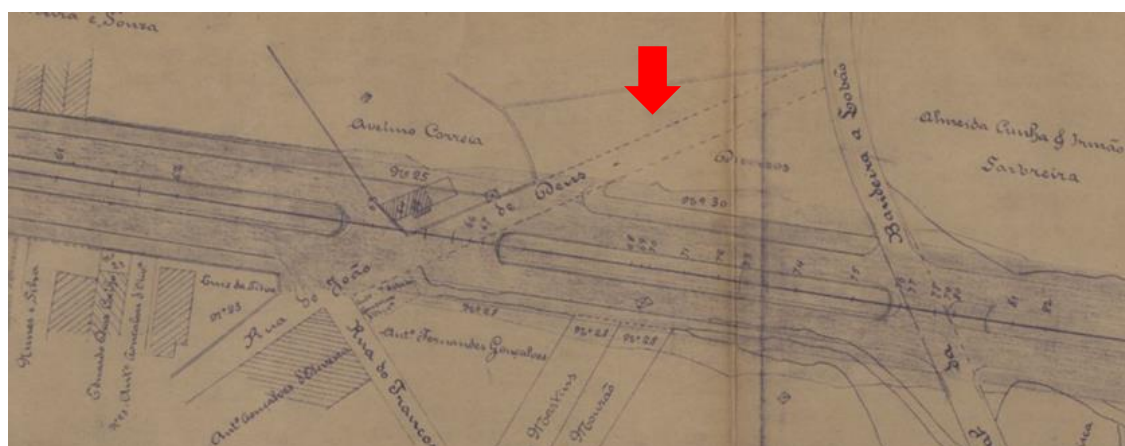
| Visível o traçado da Rua João de Deus - Extrato da Planta Geral do Projeto da Avenida. Inscrição a vermelho do autor
